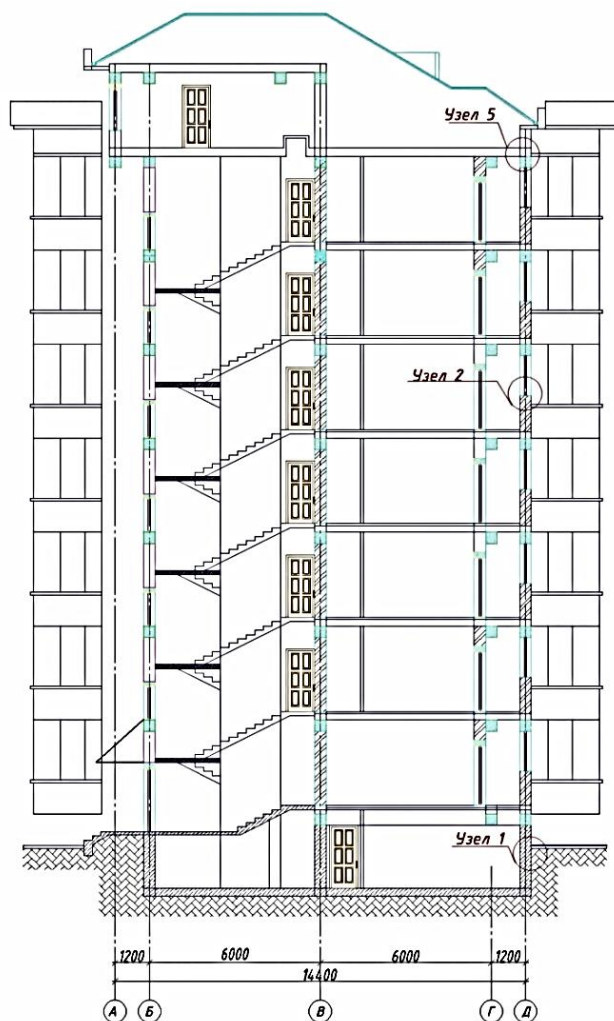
Разрез жилого дома с обозначенными узлами с тепловыми мостиками
